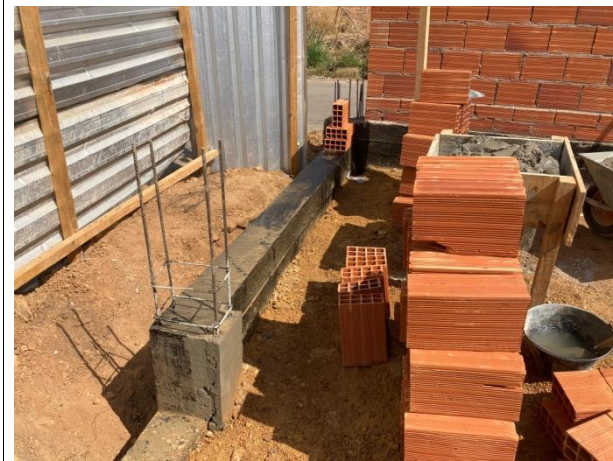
(4.0 Infraestrutura) – FABRICAÇÃO, MONTAGEM E DESMONTAGEM DE FÔRMA PARA VIGA BALDRAME
